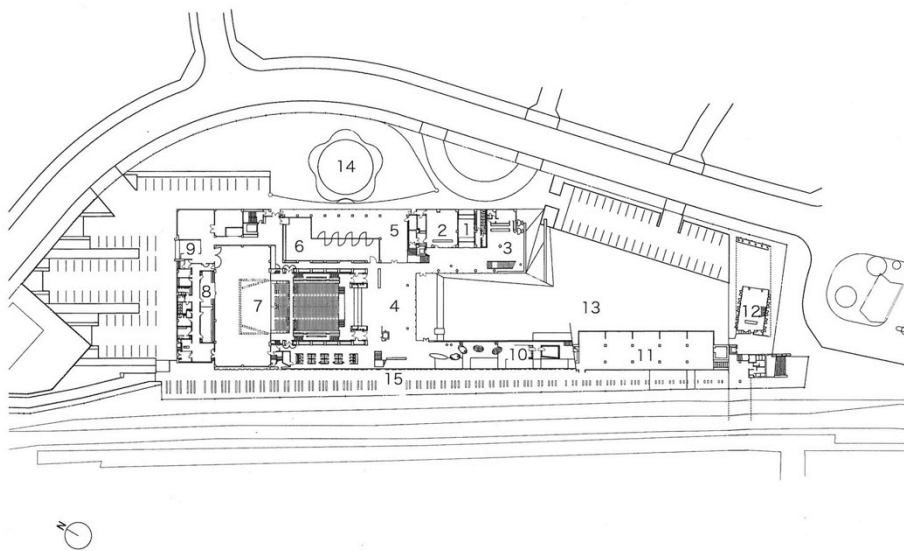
Der letzte Grundriss iErdgeschoss (ebd., 234)
